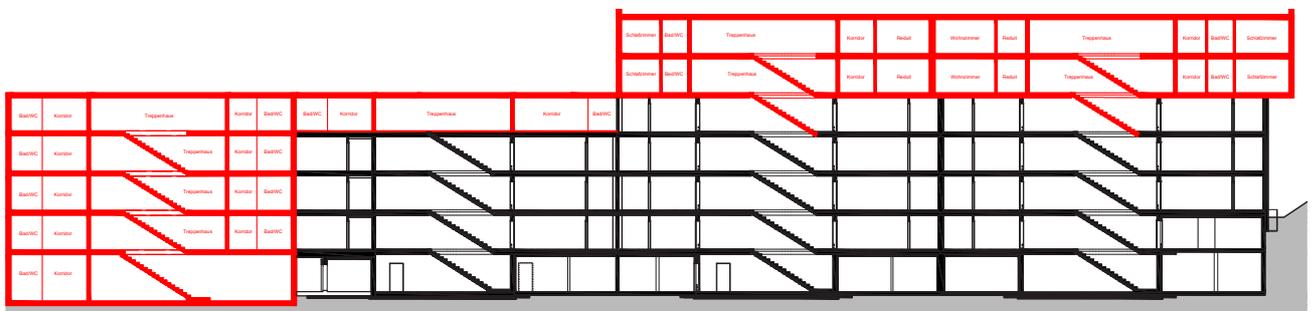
Gebäude B – Längsschnitt [Burkhalter Architekten AG]
